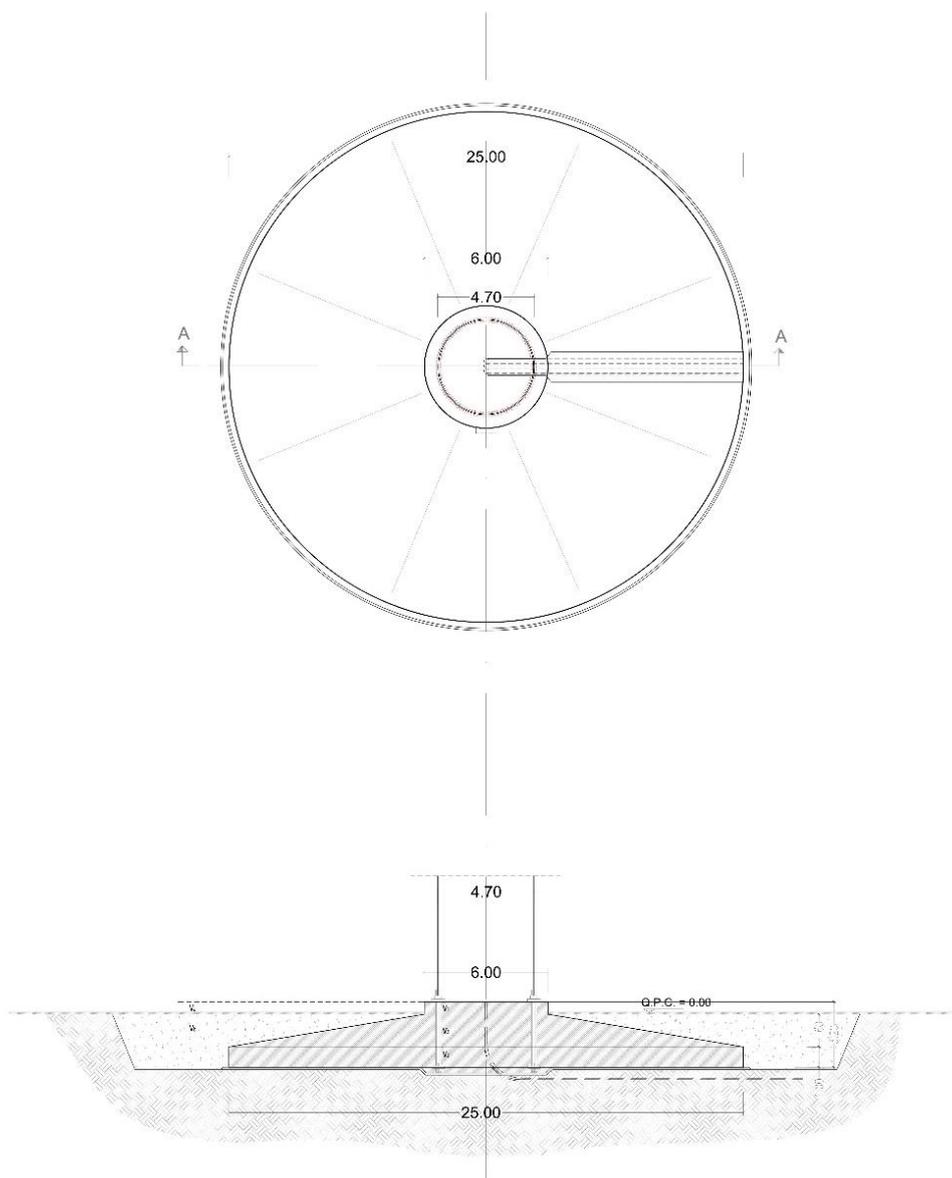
Pianta e vista della fondazione tipo dell'aerogeneratore
